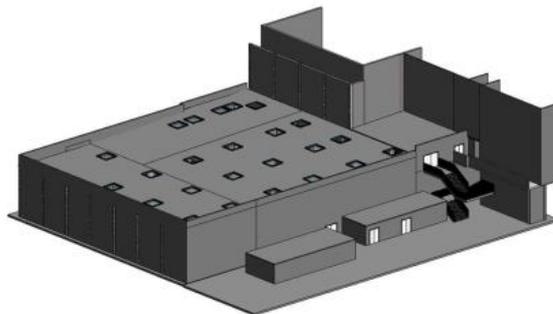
Modelo BIM: plantas *Autocad* (.dwg).
